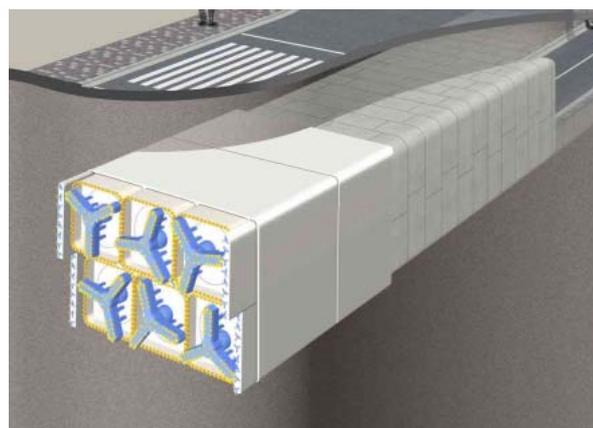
URUP工法の概要図 (トンネル部の施工)
